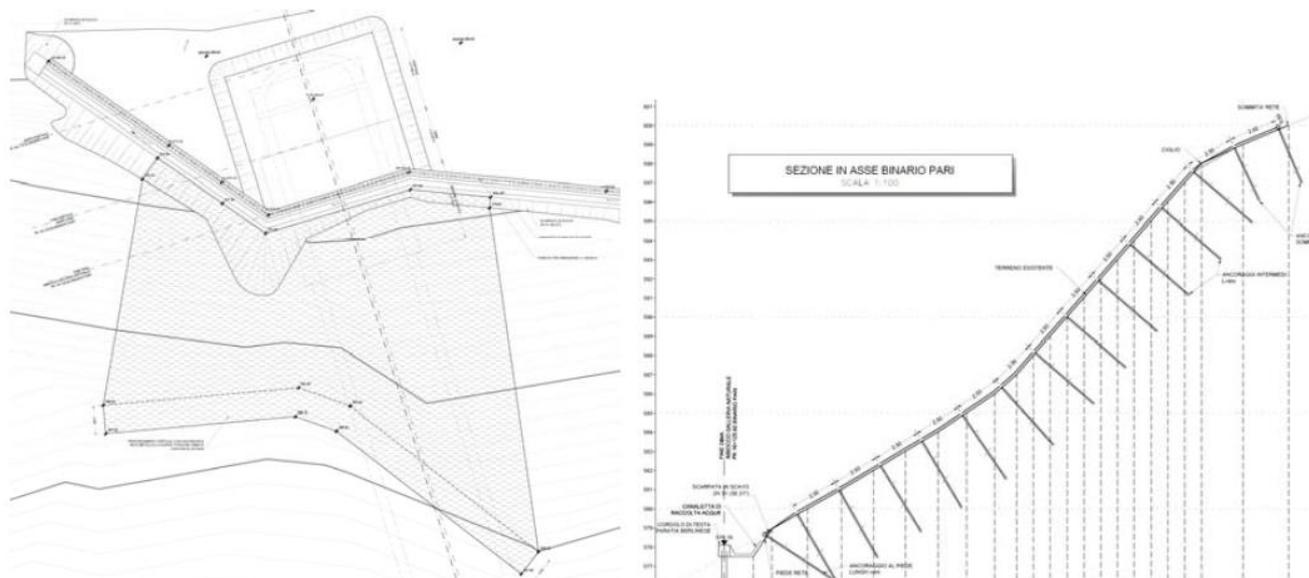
Galleria Gardena – Imbocco Nord – Rafforzamenti corticali del versante
